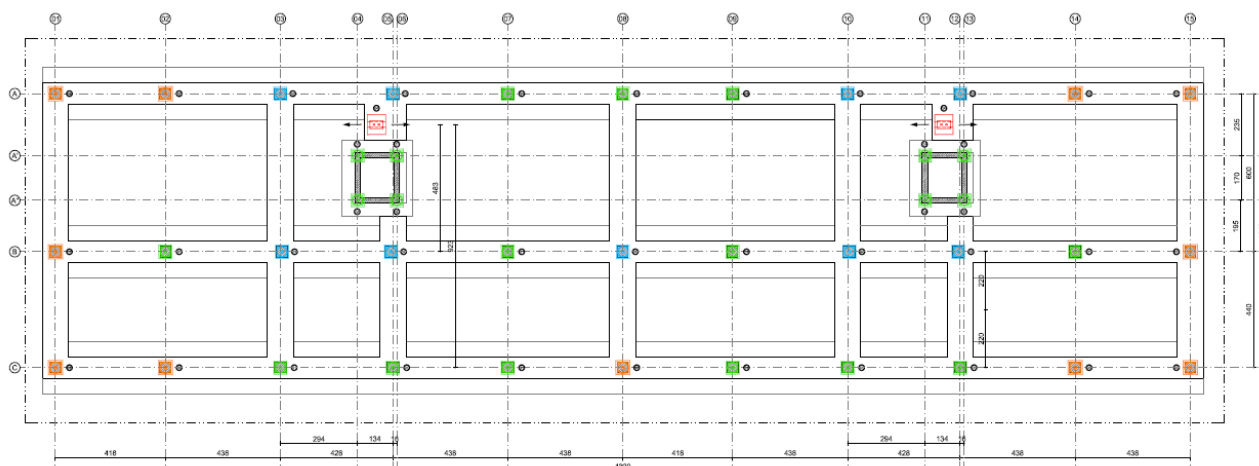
Stato di progetto – Struttura – isolatori al piano terra.
